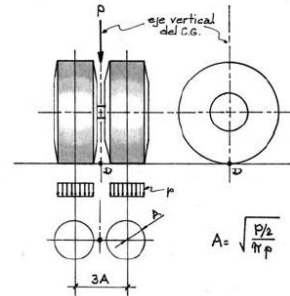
Centro de gravedad y correcta posición de la VIGA DE BEMKELMAN
